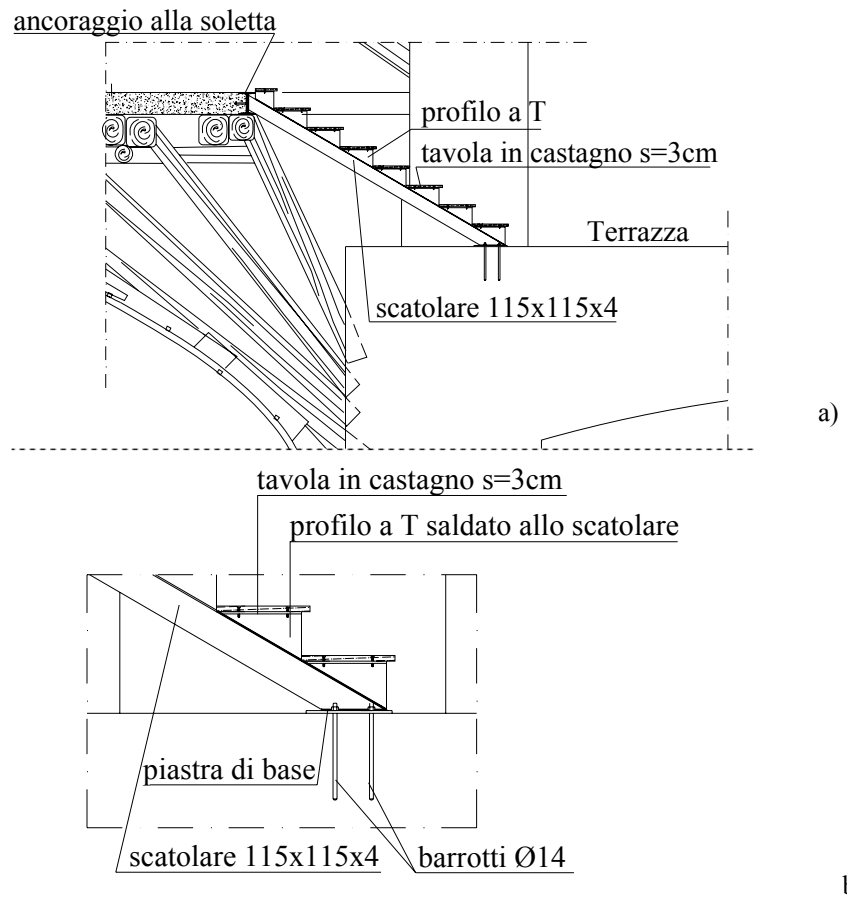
Scale di accesso alla sala: a) Sezione; b); Particolare gradino e fissaggio al solaio.
